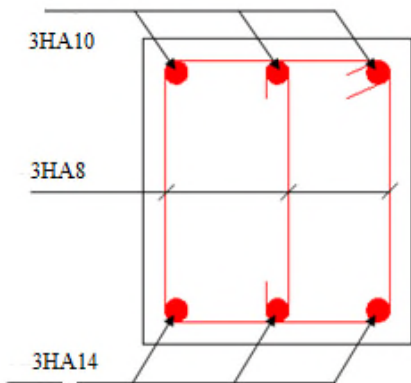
schéma de Ferrailage de la poutre de chaînage.
